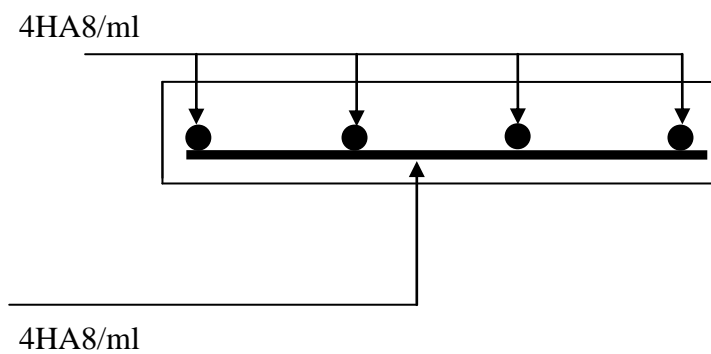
schéma de ferrailage de la dalle pleine sur un appui
